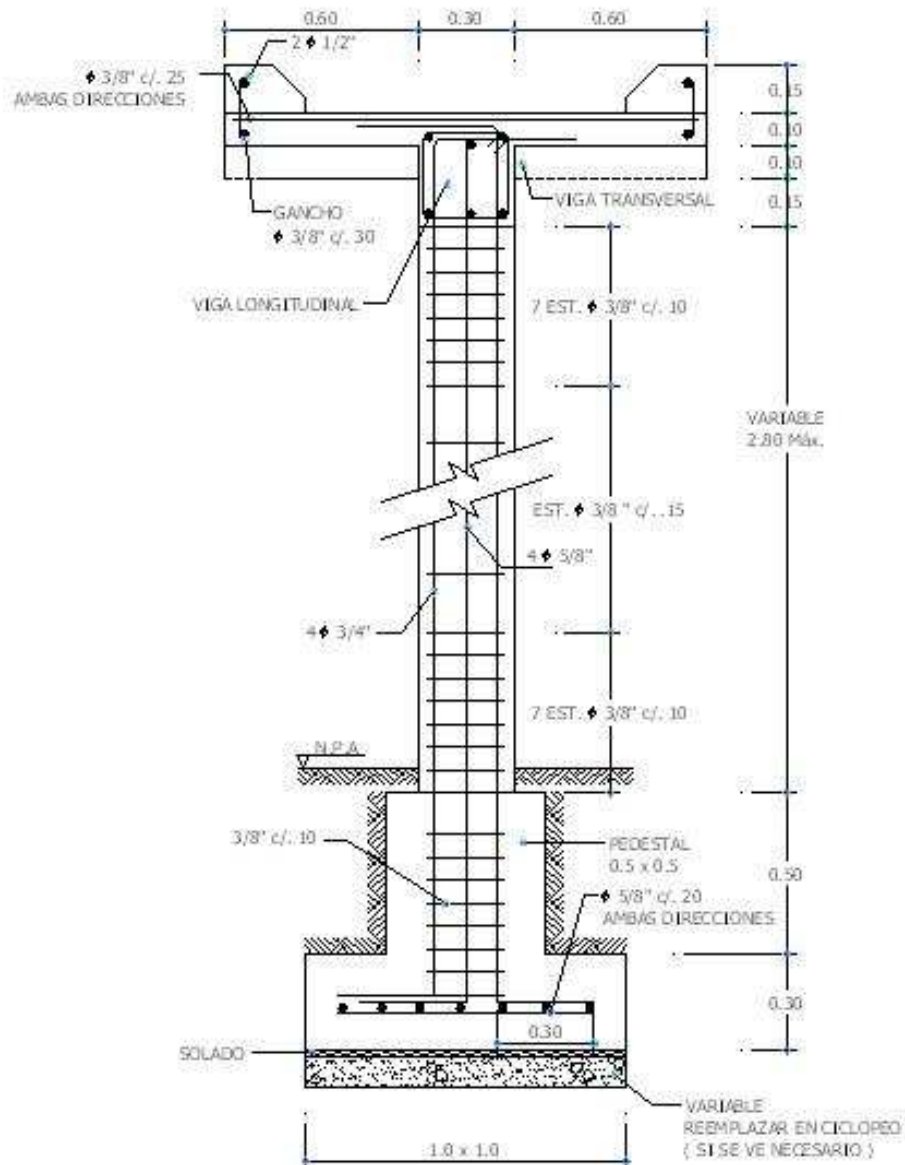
Alzado de la columna del viaducto peatonal con detalle estructural.
